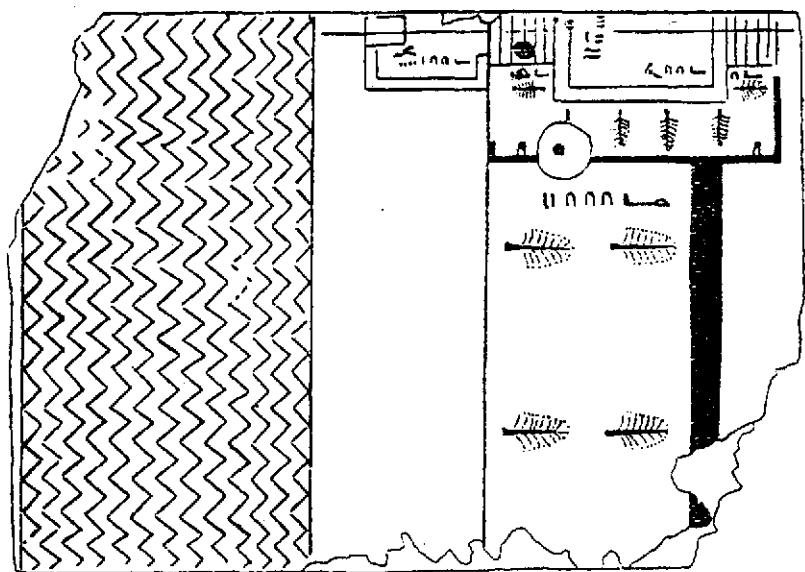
Plan dressé par un architecte, avec indication des longueurs en coudées (Nouvel Empire).
